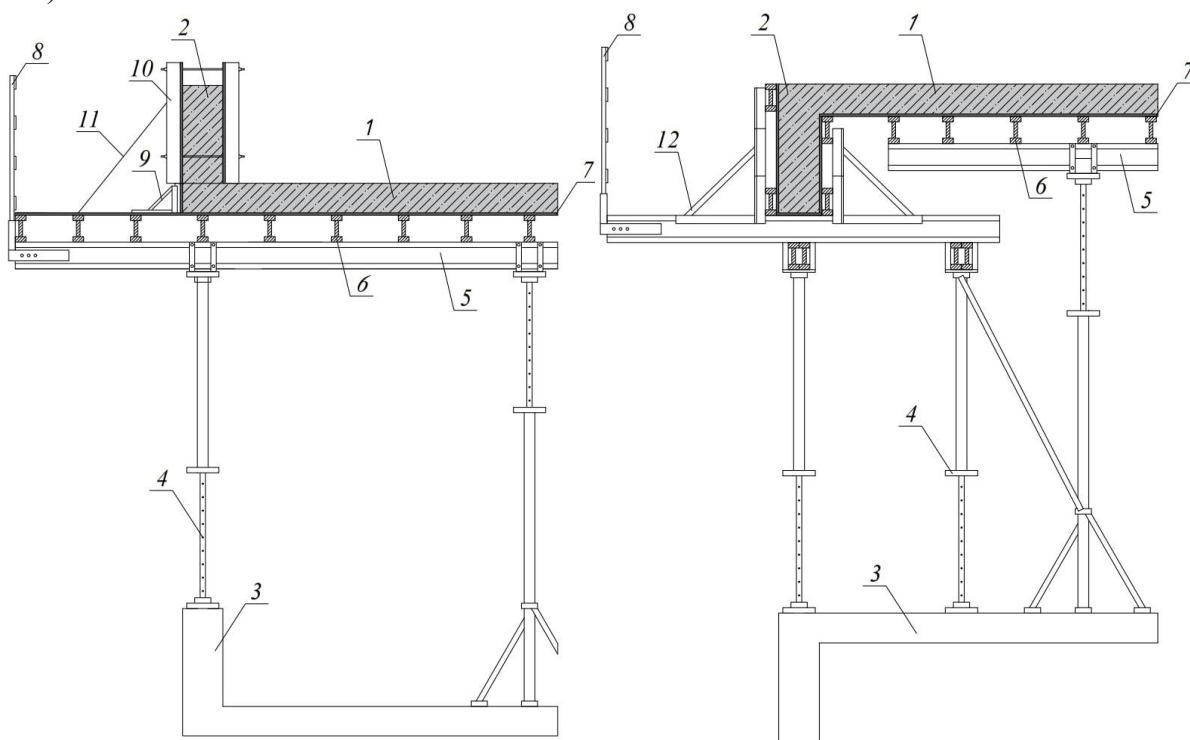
Схемы монтажа опалубки краевого ребра перекрытия:
